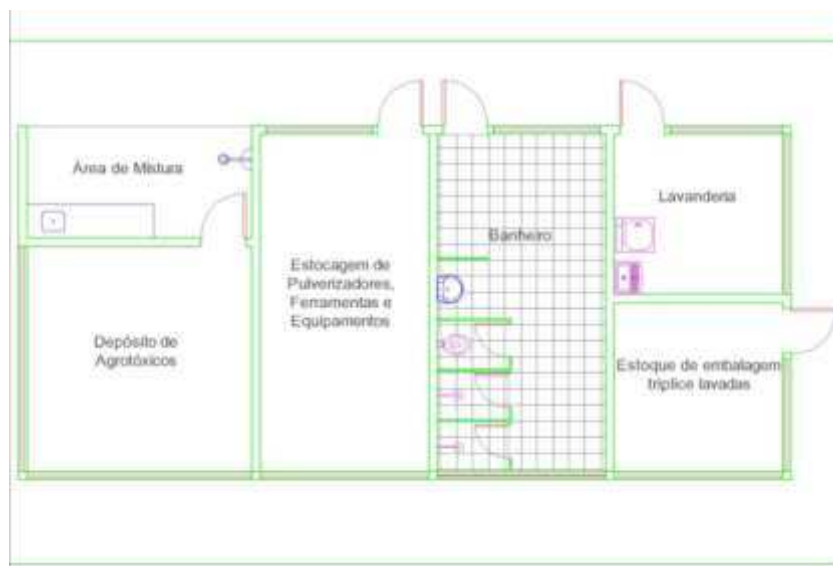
Planta do Prédio Gerecamp (fonte: Embrapa)
